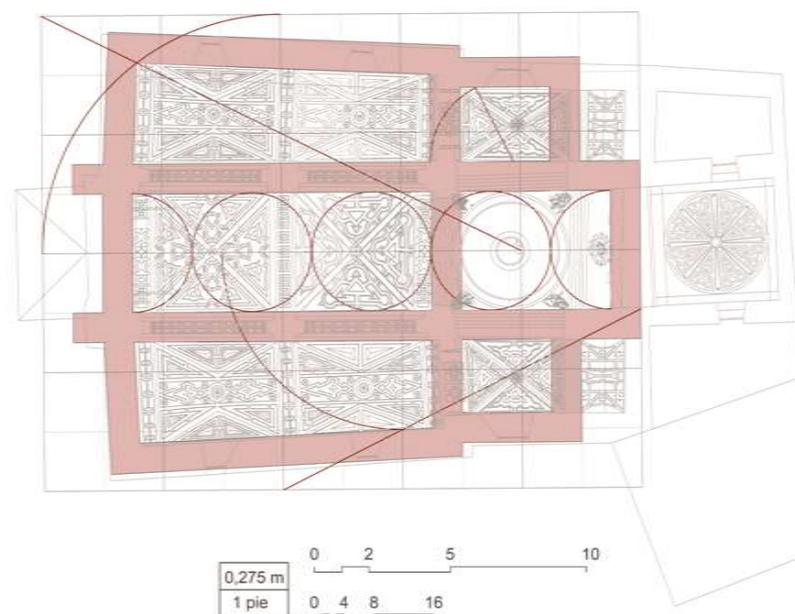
Superposición de las trazas propuestas para Santa María de Olleros sobre la planta actual.
